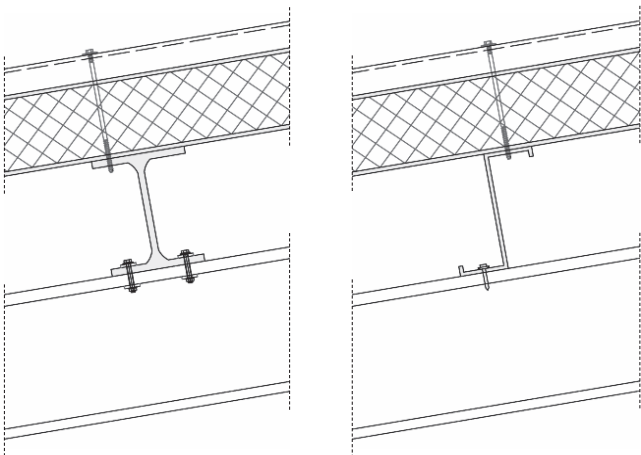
Pfetten aus Walz- oder Kaltprofilen als Unterkonstruktion für Dachsandwichelemente
